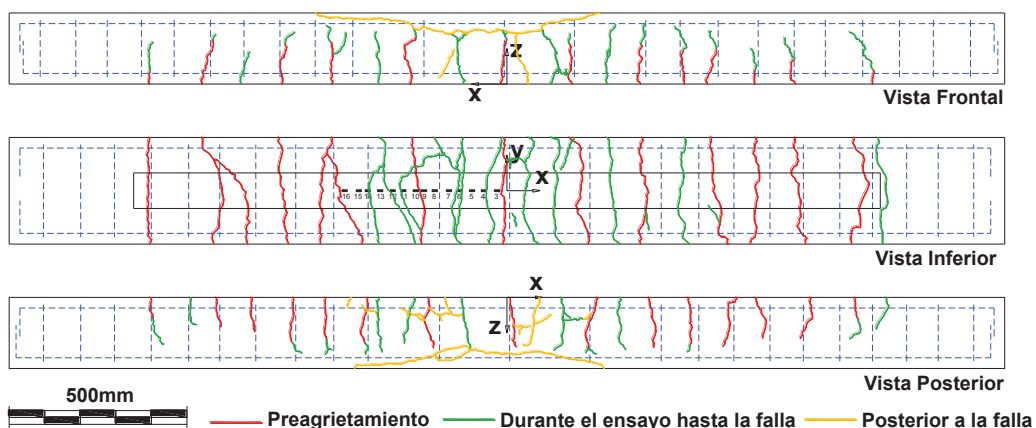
Esquema del patrón de agrietamiento de viga 1A durante el ensayo por carga última.
